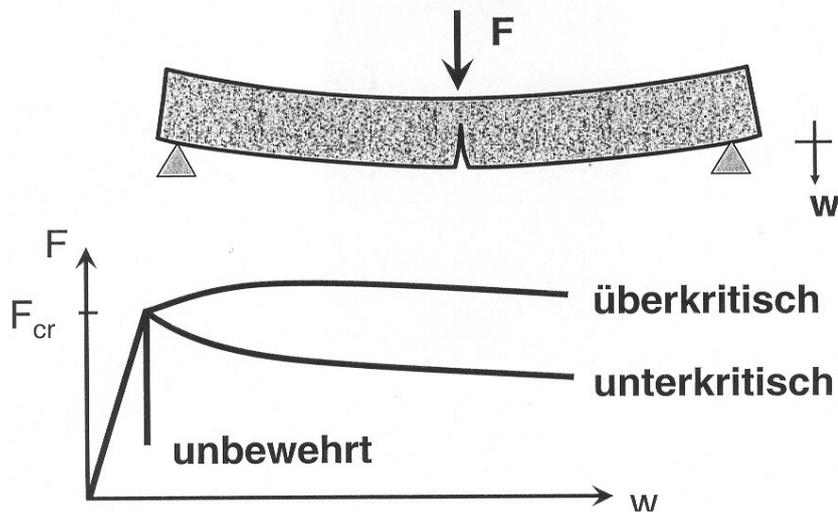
Last – Verformungsbeziehung unbewehrter Beton / Stahlfaserbeton
